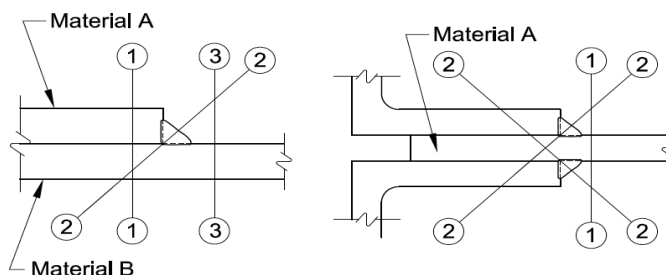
1 Planos de corte para soldaduras de filete cargadas en cortante longitudinal
